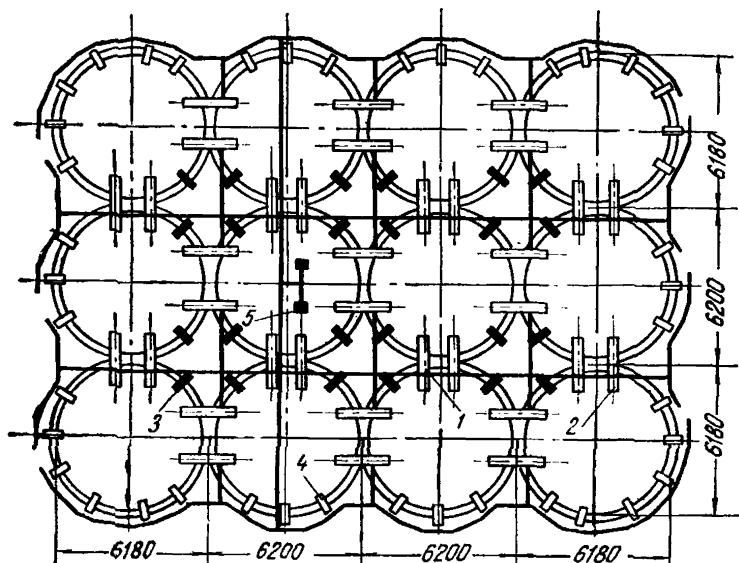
Схема стальной опалубки силосного корпуса с домкратами и разводкой
